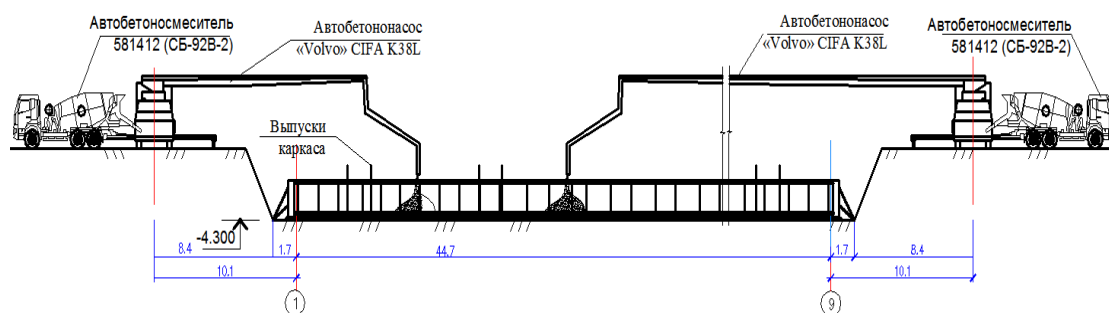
Подача бетона в конструкцию бетононасосом
